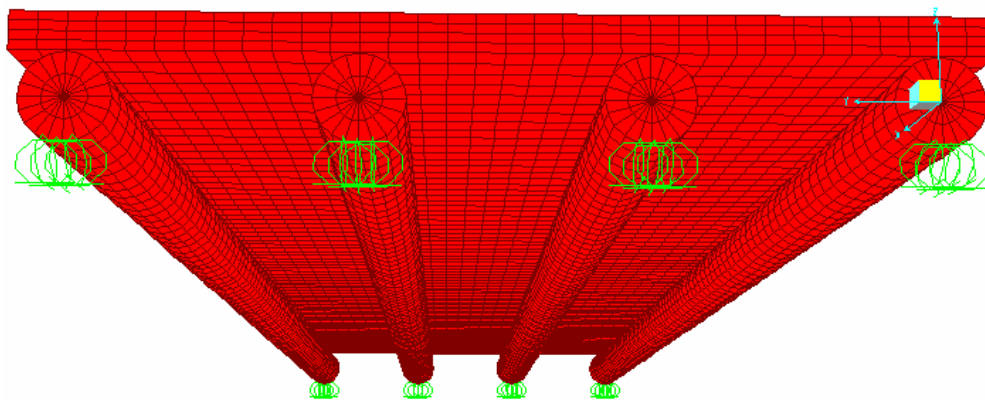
Vista em três dimensões da parte inferior do tabuleiro de madeira-concreto
